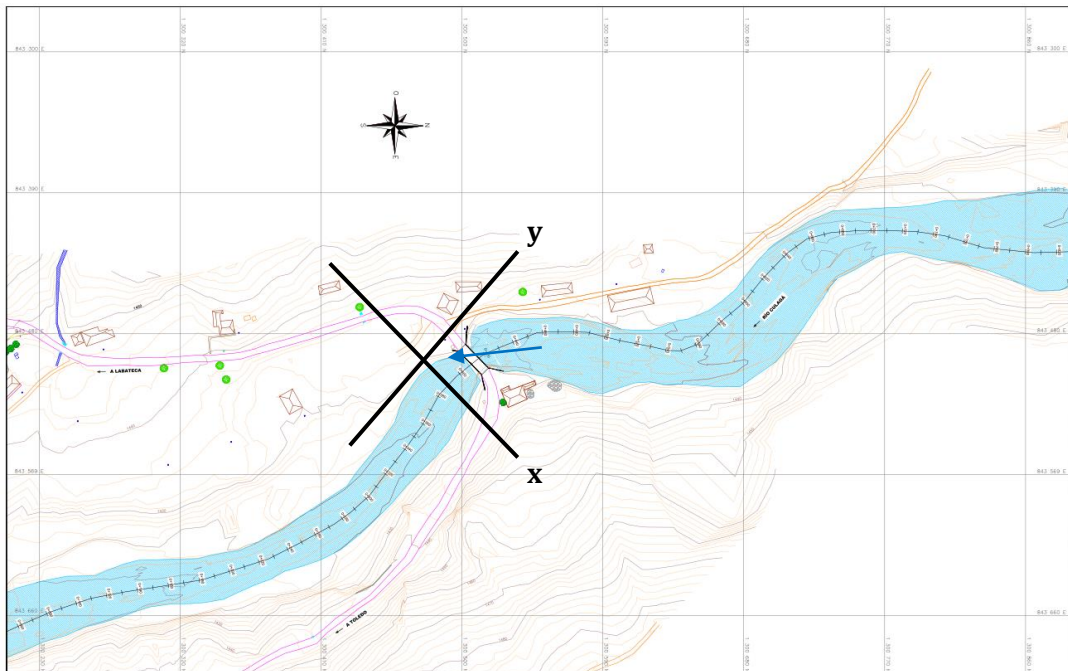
Vista en planta geometría río Culagá (Hec-Ras)
